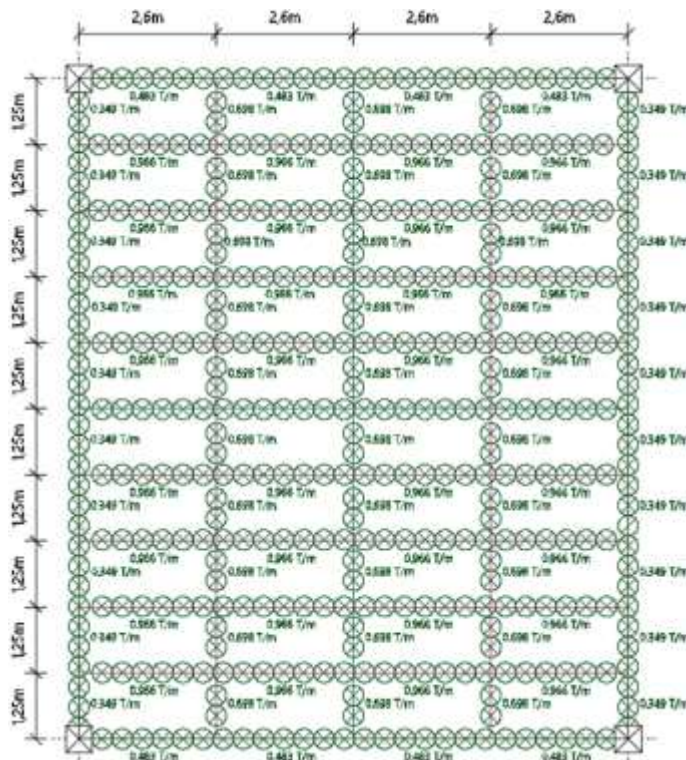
Cargas verticales que gravitan en la losa para el cálculo del desplazamiento vertical
